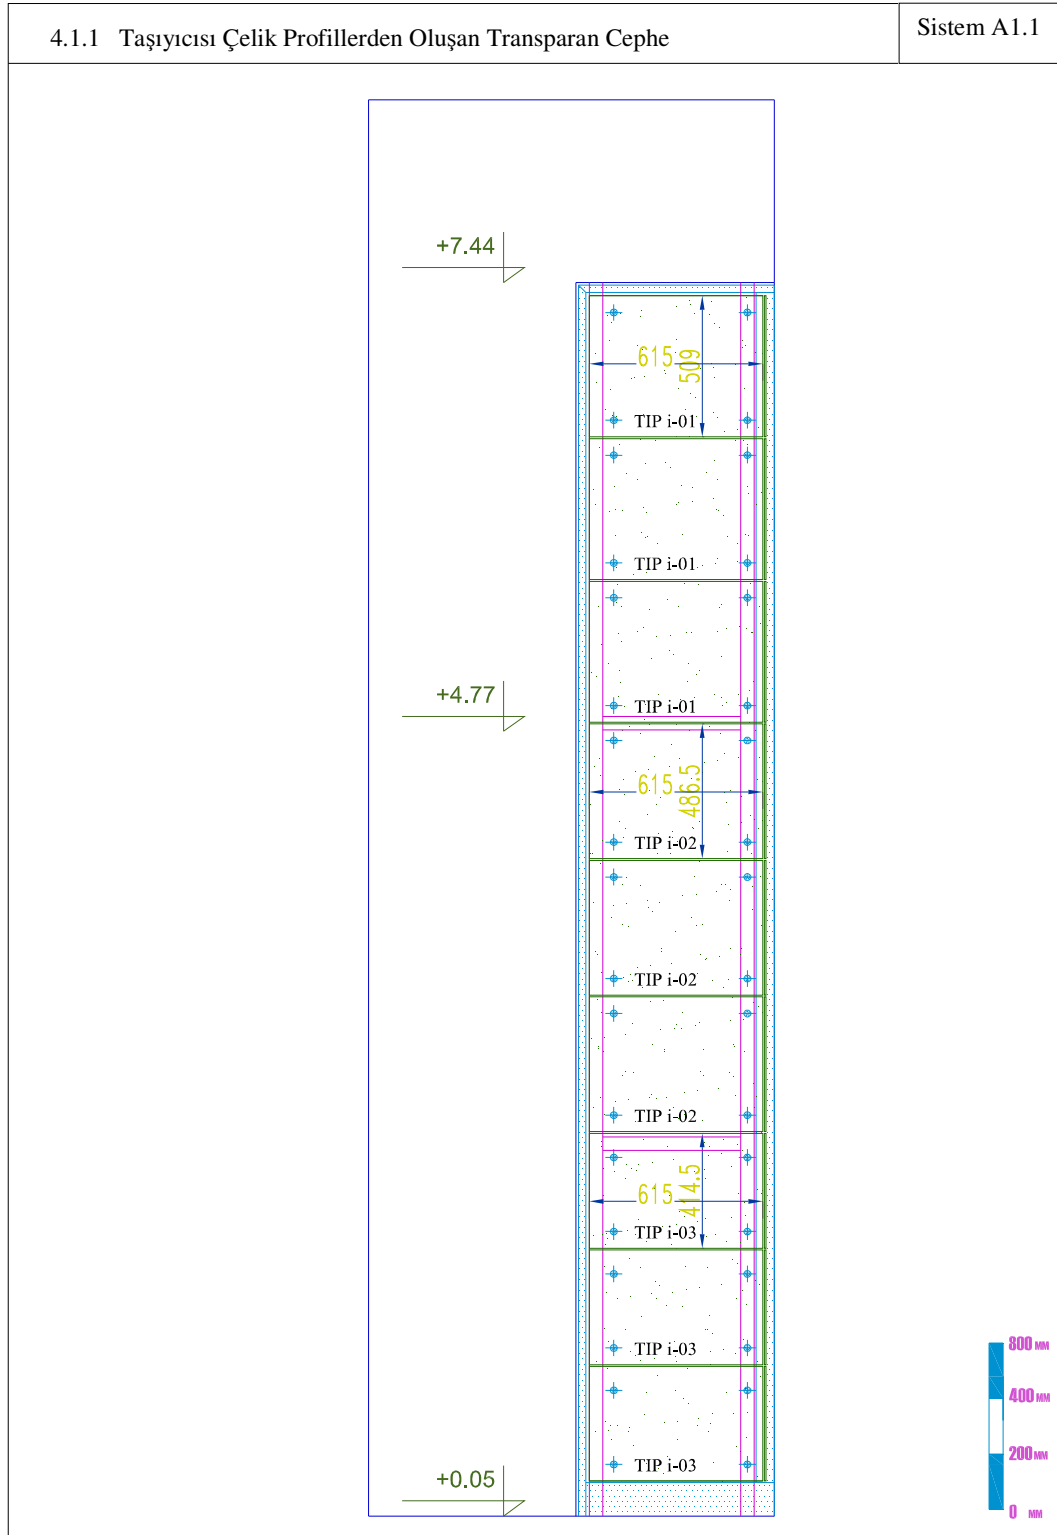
Çelik taşıyıcılı transparan cephe planı ve köşe sistem detayı
